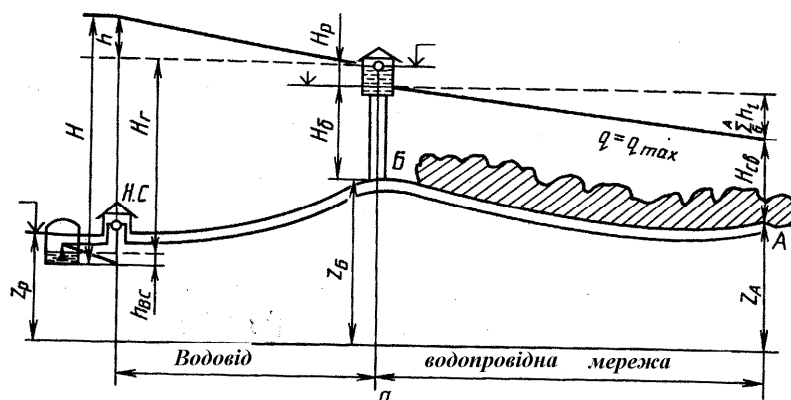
Схема роботи водопроводу при господарсько-питному водоспоживанні
